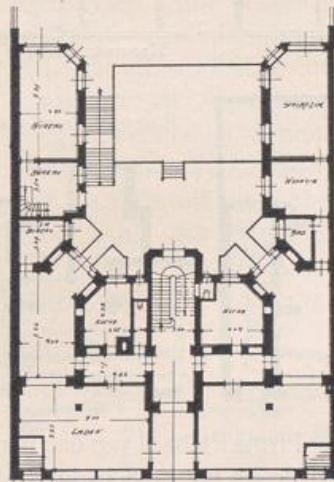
Grafenberger Chaussee 32/34. Erdgeschoss. 1:500.
